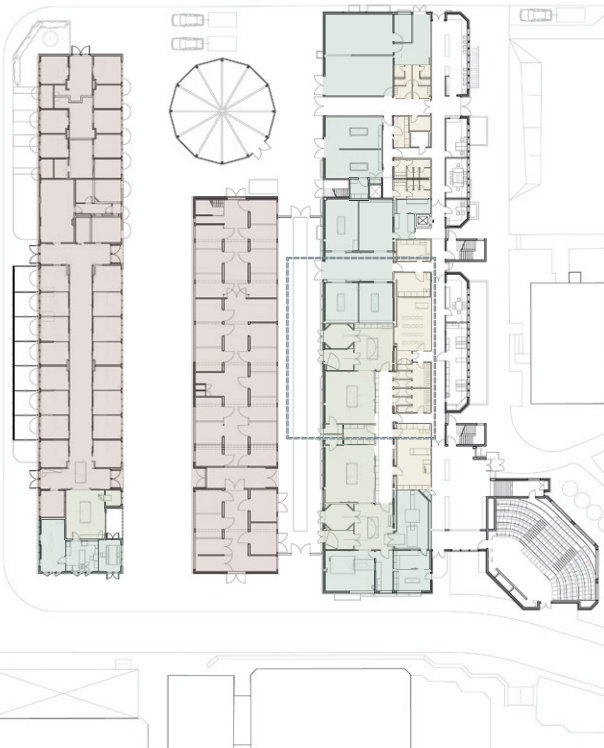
Grundriss Erdgeschoß Freie Universität Berlin - Klinik für Pferde- Bereiche nach Funktionen
